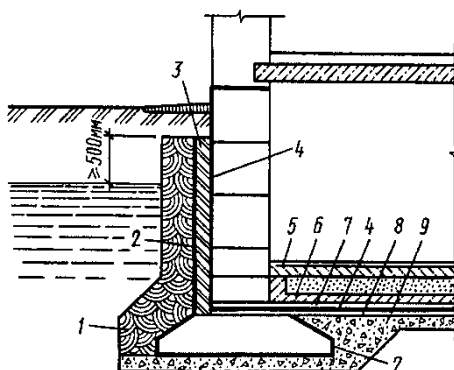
Изоляция фундаментов от агрессивных подземных вод:
